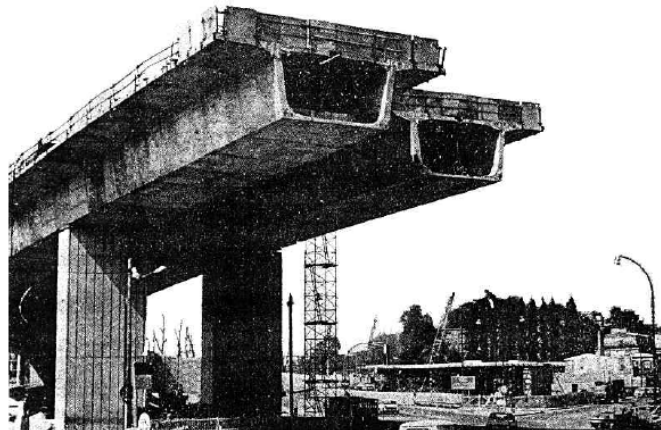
Puente en construcción de traveses tipo cajón.
